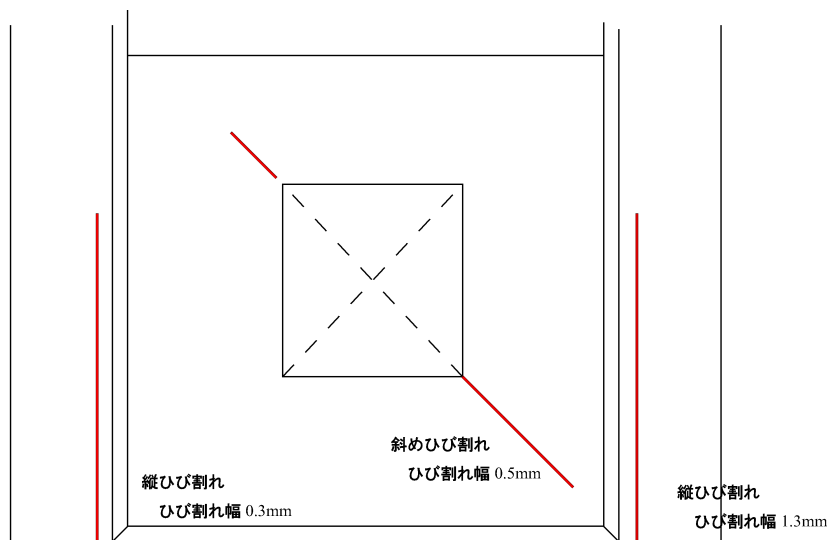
図 B: 耐力壁のせん断ひび割れと側柱の縦ひび割れの概要
